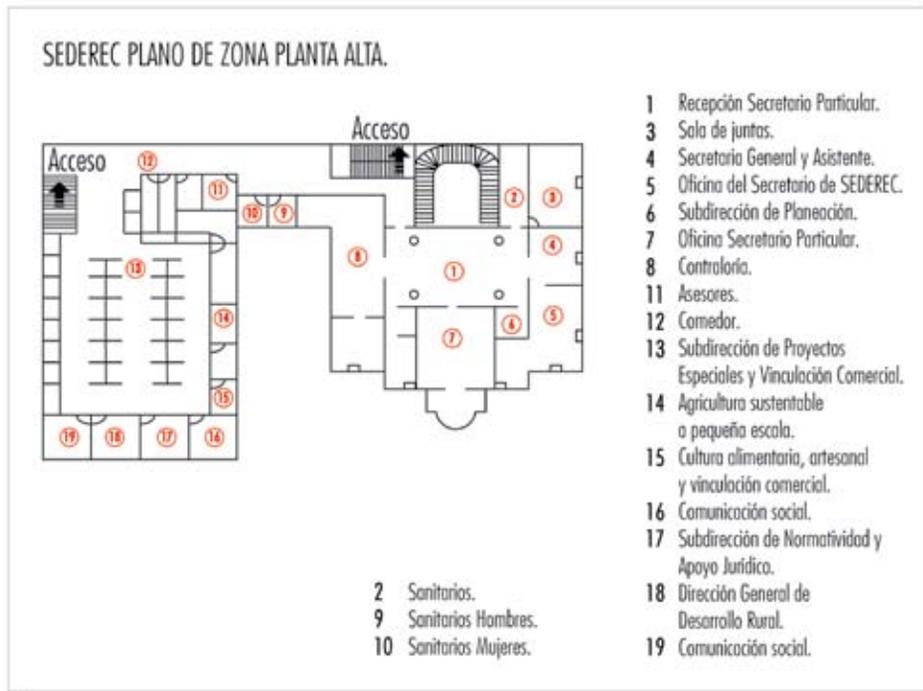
Plano planta alta. Accesos, oficinas y servicios.
